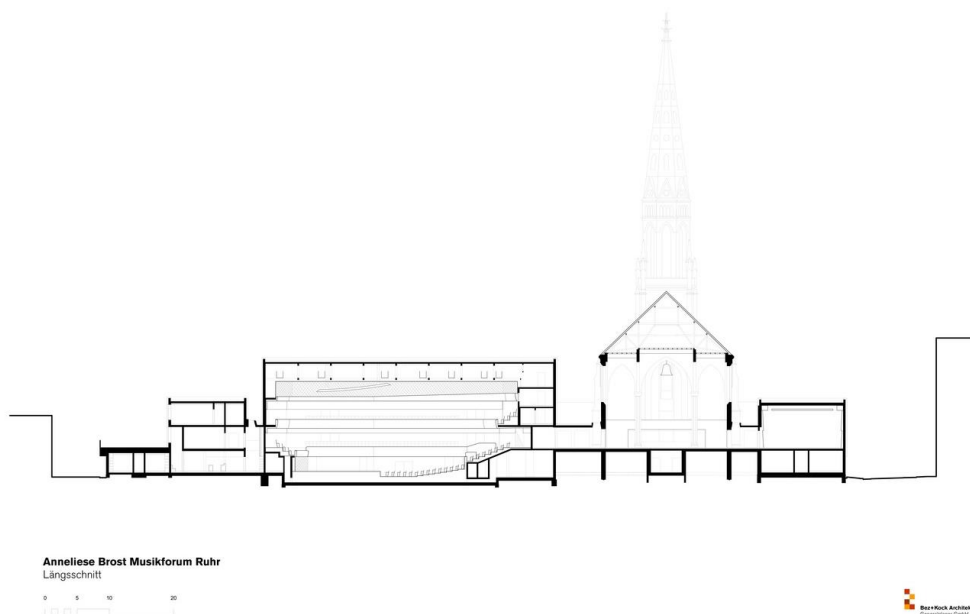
Coupe à travers le Musikforum de Bochum (ArchDaily, 2017)
